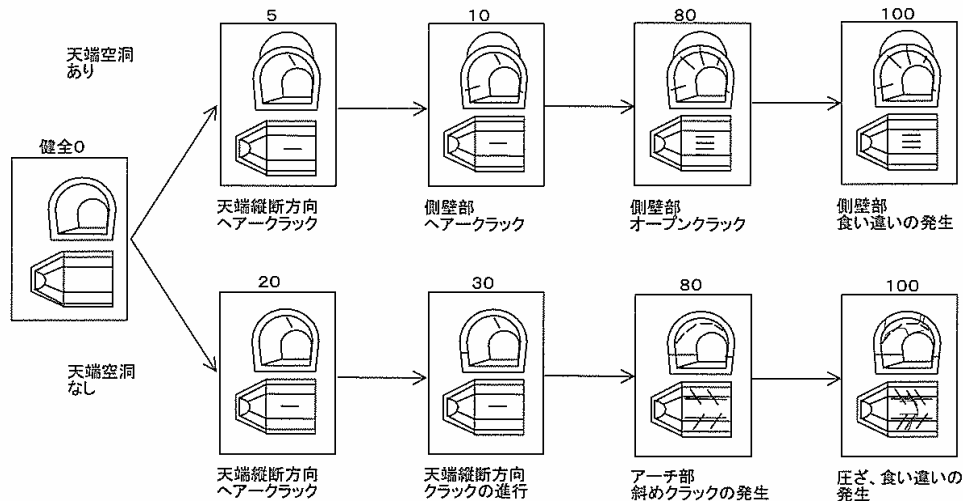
ひび割れ発生パターンの進行図の一例³⁾
